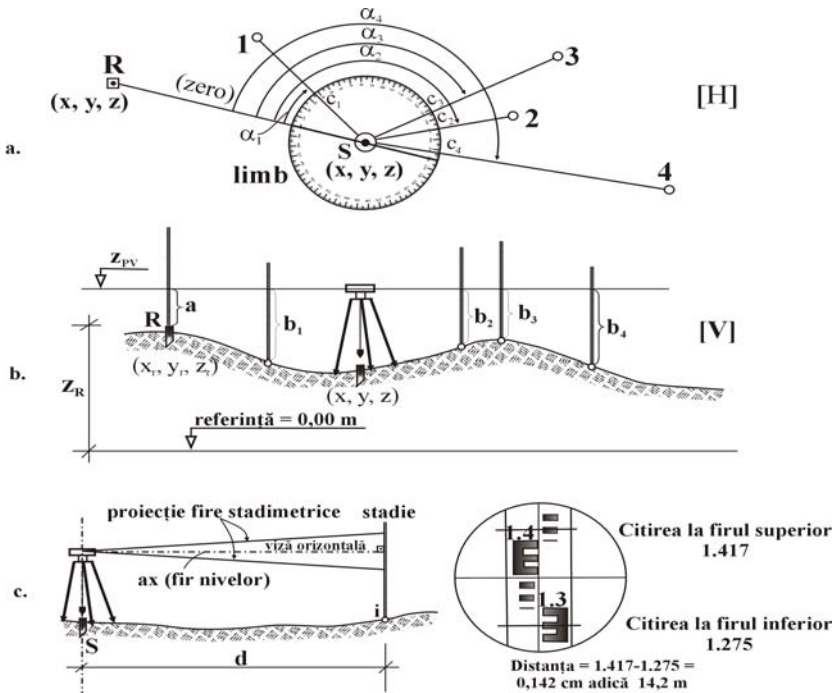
Radieri cu nivelul: a- vedere în plan orizontal, b- secțiune verticală, c- măsurarea distanțelor
